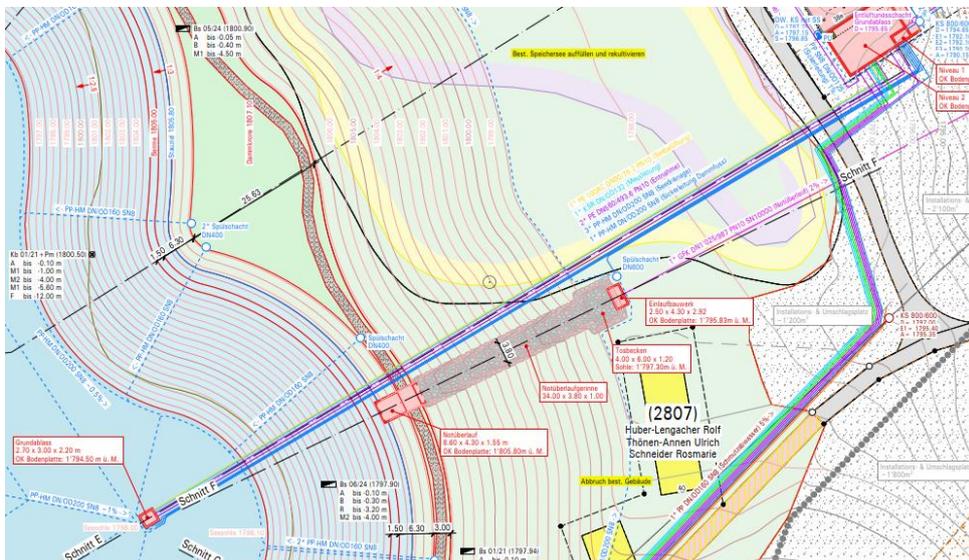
Grundablass und Notüberlauf gemäss Bauprojekt Situationsplan (Quelle: Steiger Ingenieure + Planer AG)
